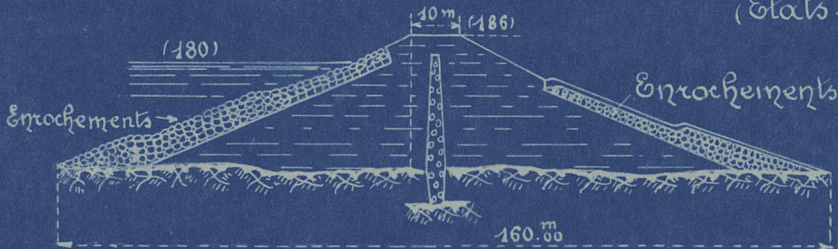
Coupe type d'un barrage en terre graveleuse projeté pour une hauteur de 33 m. de retenue (d'après M^r Eydoux)
